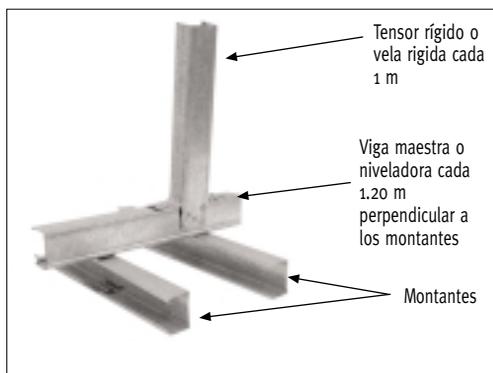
Detalle encuentro montantes, viga maestra y velas rígidas
